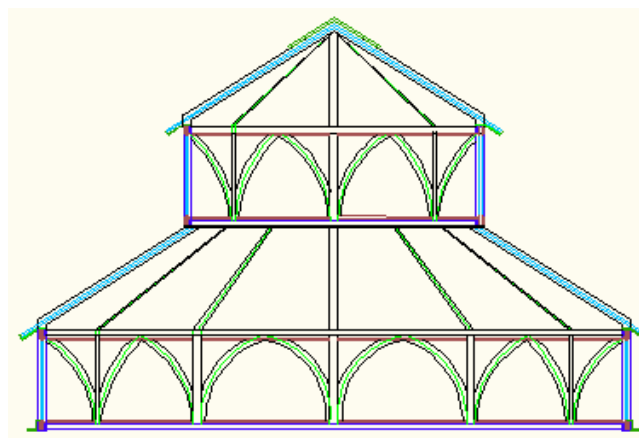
Desenho ilustrativo da estrutura do coruchéu mais elaborado. (desenho do autor)
